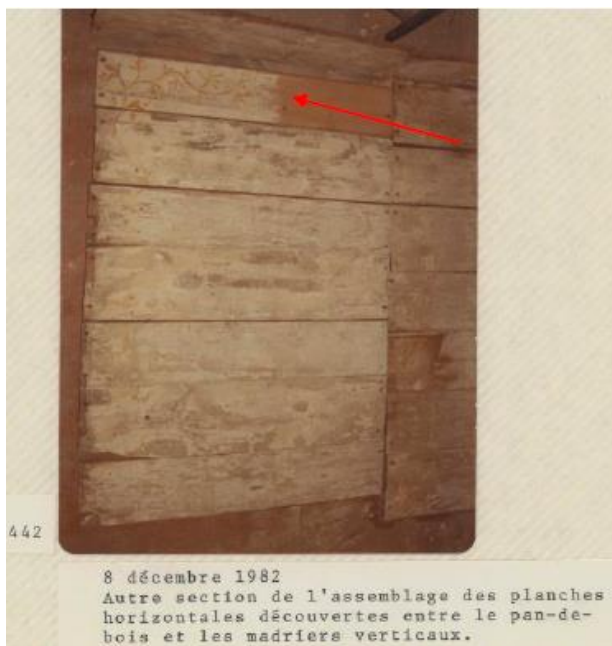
assemblage de planches visibles sur le côté gauche de la murale. Des motifs floraux sont visibles sur la planche supérieure. Photo de 1982
